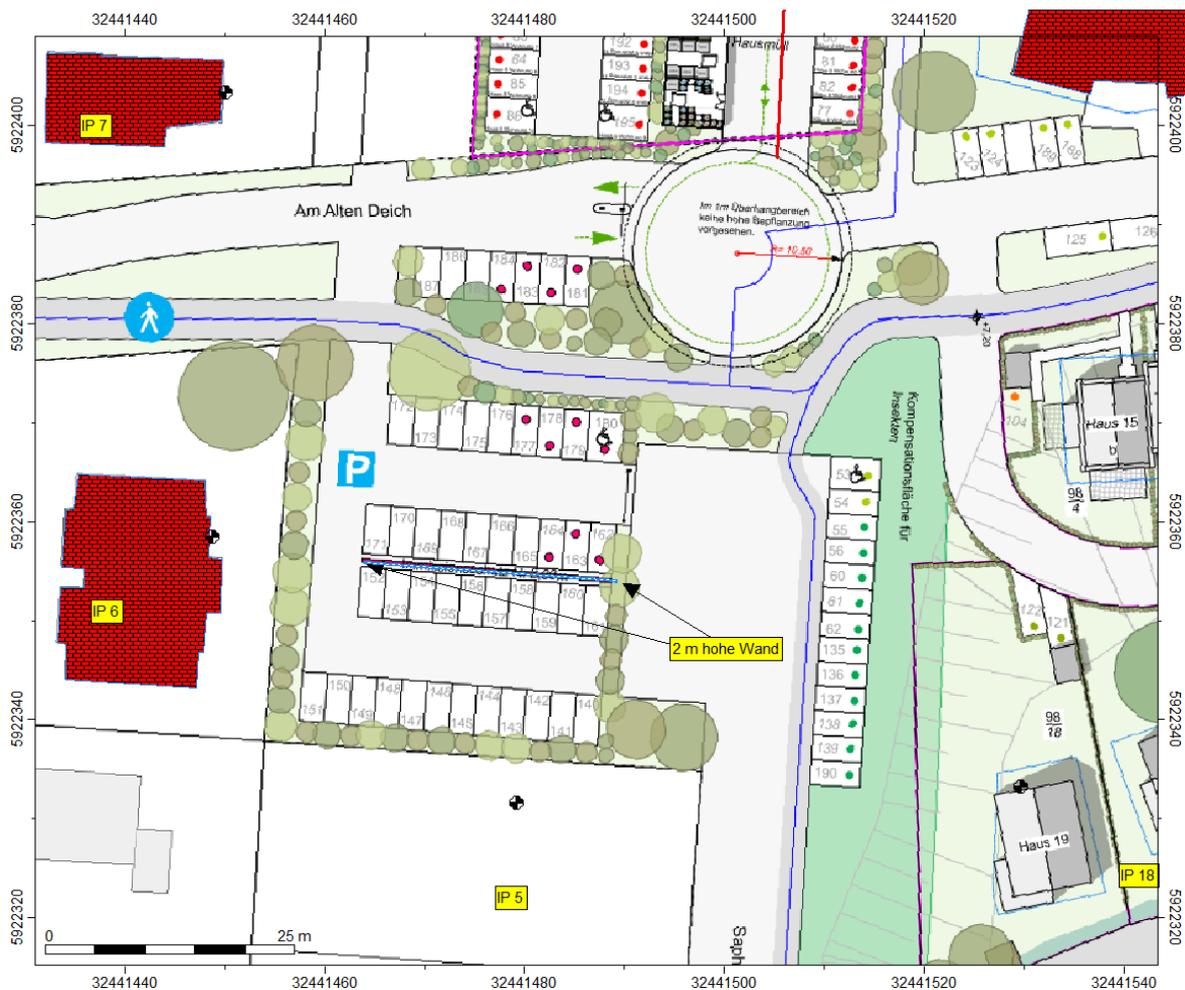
Lageplan mit dem Verlauf der 2,0 m hohen Schallschutzwand.
